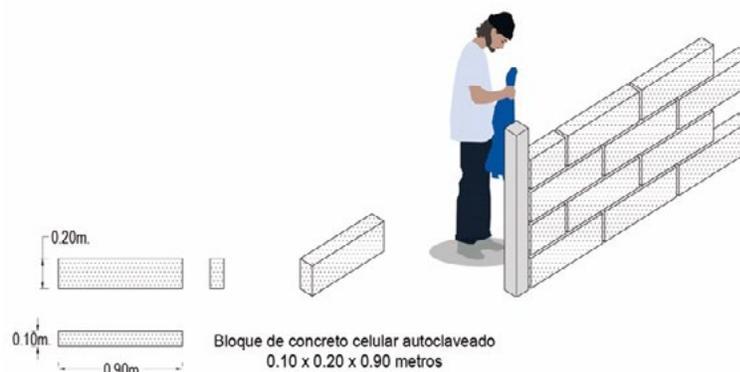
Bloque de concreto celular autoclaveado (fuente: Elaboración propia, 2018).
